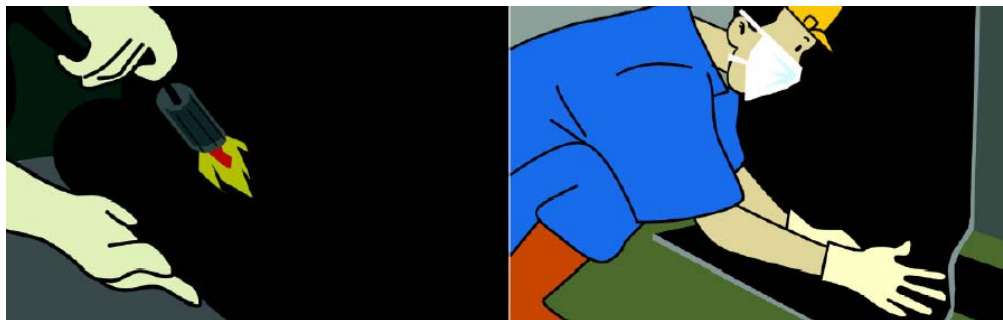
Exemplo de aplicação de manta asfáltica com maçarico (fonte: Retirado de documento da construtora X).
